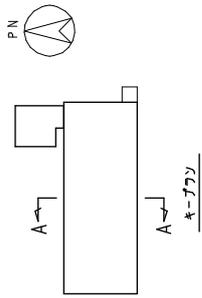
固体廃棄物貯蔵庫第9棟 地下1階 平面図 (単位 : m)
